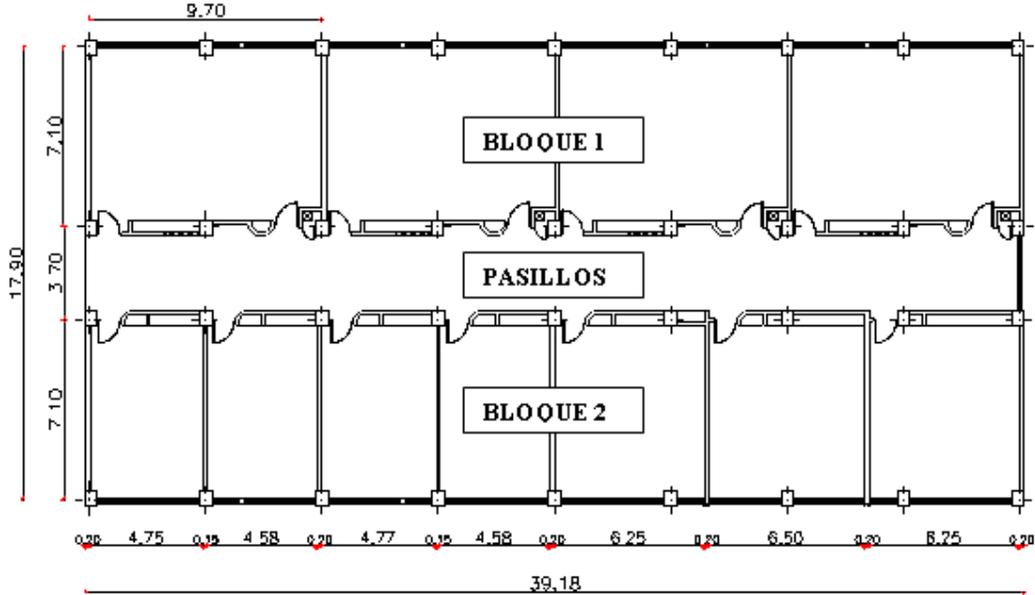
Planta Baja y Planta Alta Tipo<sup>20</sup>
